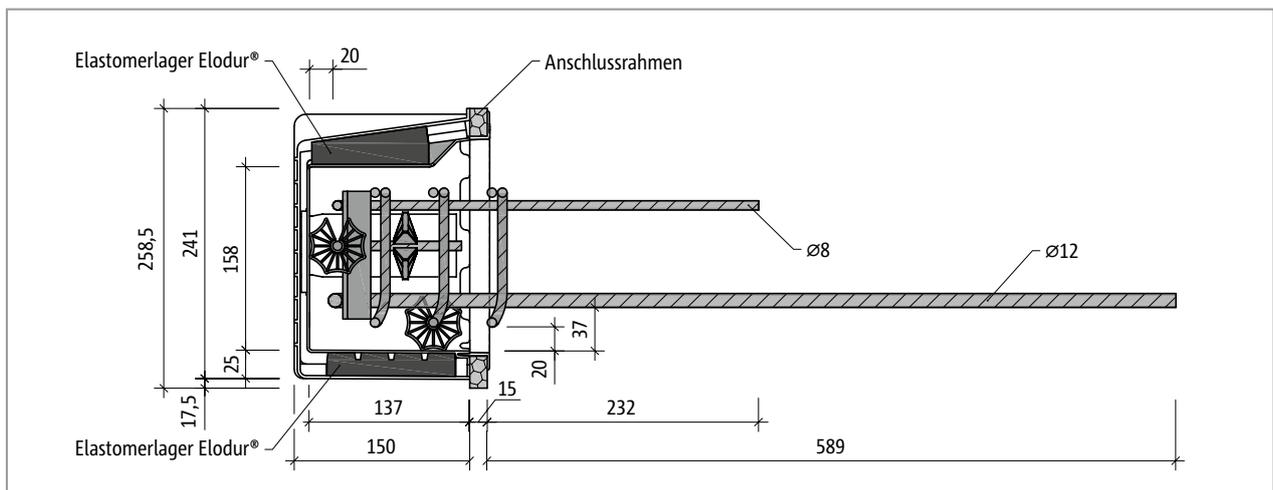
Schöck Tronsole® Typ Z-V+V-T beziehungsweise Typ Z-VH+VH-T: Vertikalschnitt
